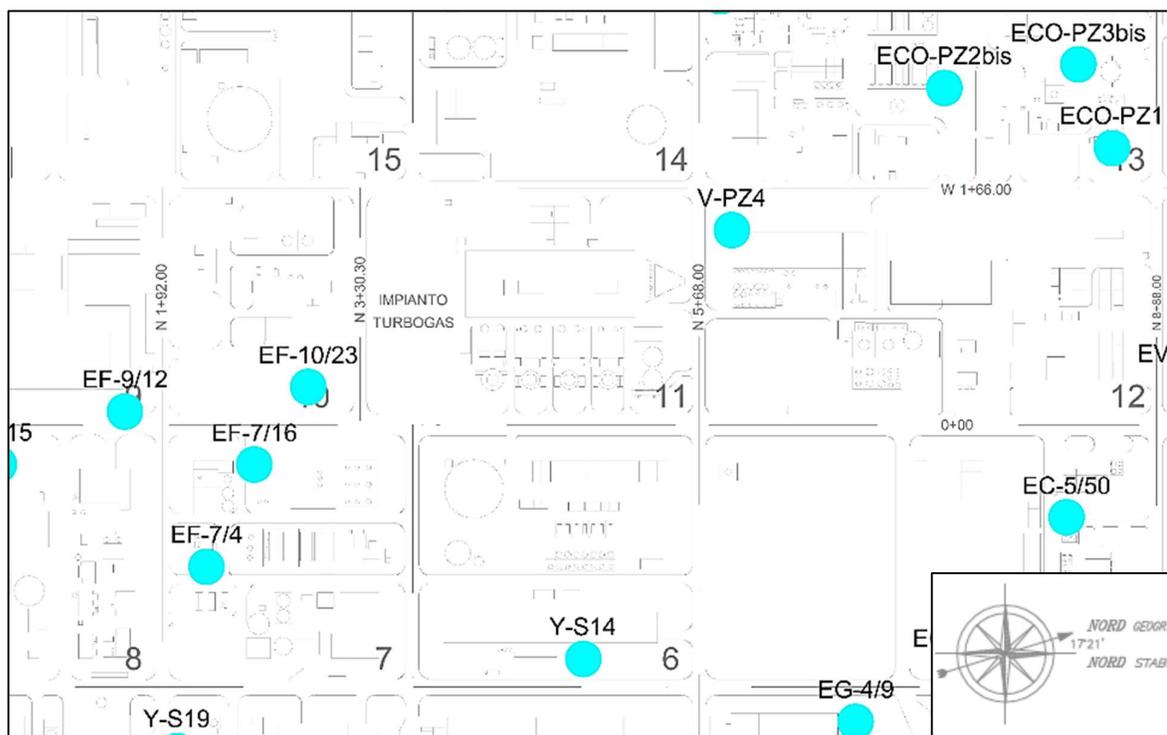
Ubicazione dei piezometri di monitoraggio rispetto all'area d'intervento
